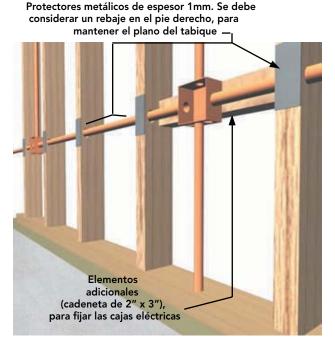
5: Consideraciones para la instalación, fijación y protección de ductos y accesorios.
